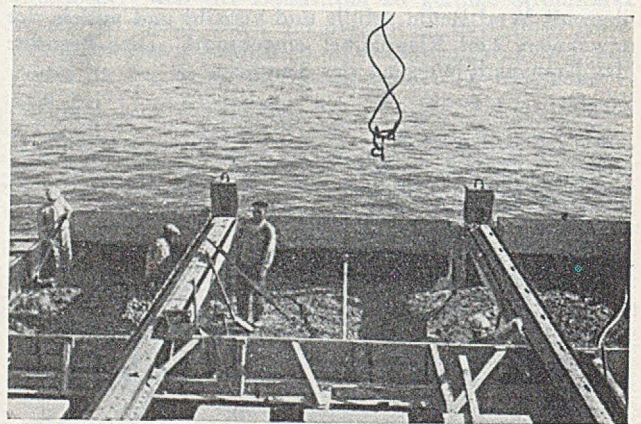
Verlängerung des Kranhakens auf einer Brücke in den neuen Betonierblock.
